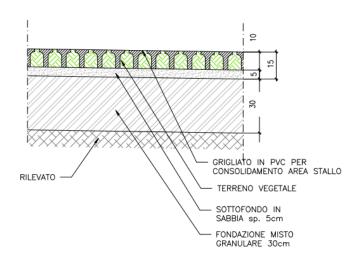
Sezione tipo degli stalli dei parcheggi drenati
